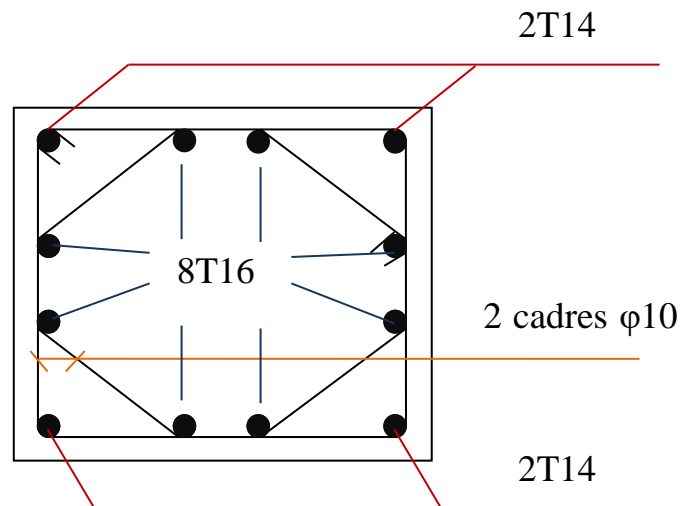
dessin de ferrailage du poteau (50×50)
